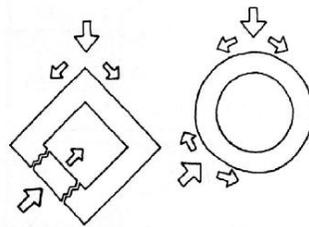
(von links nach rechts) Vergleich rechteckiger Grundriss zu rundem (Houben et al., 1995)
